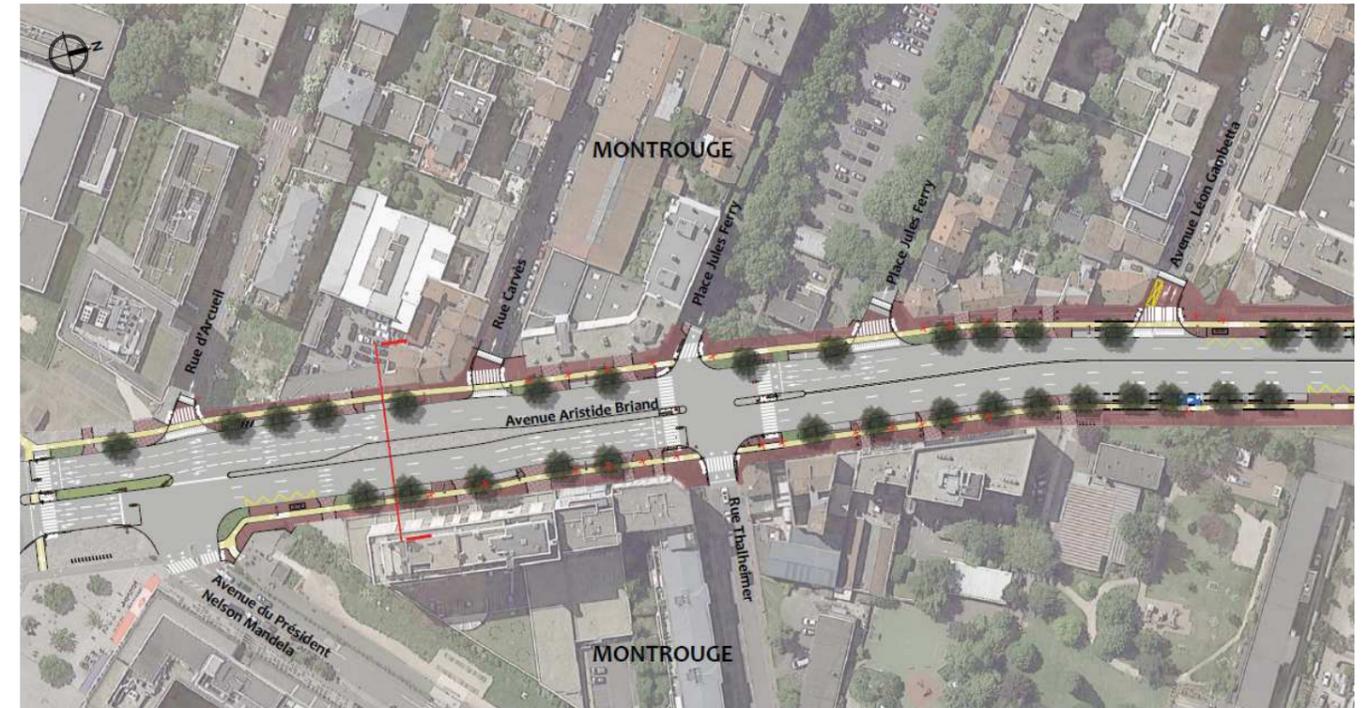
Plan des aménagements, section Carrefour de la Vache Noire – Avenue Léon Gambetta
